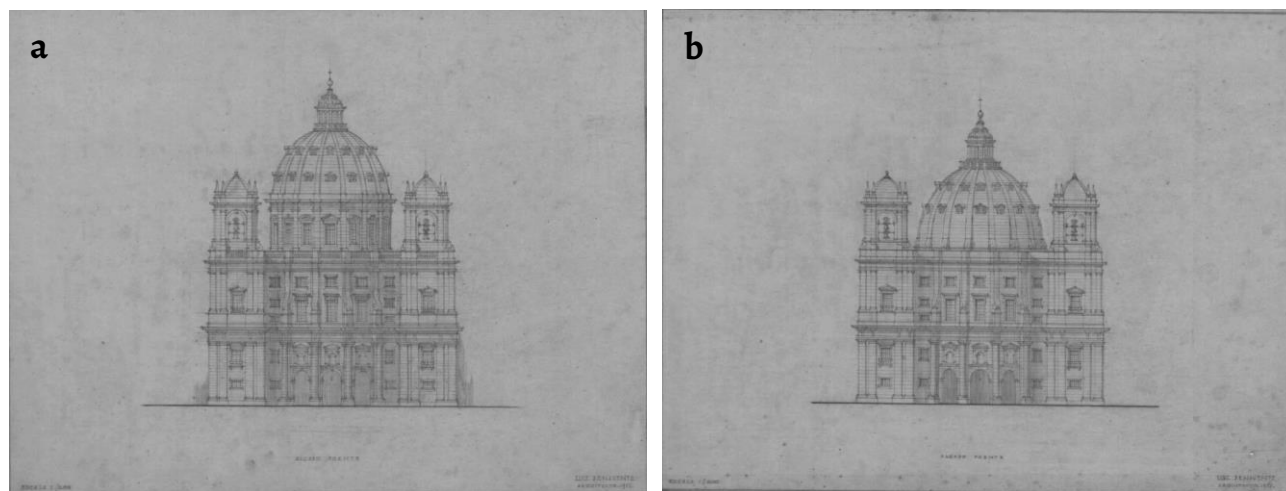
Propostas para conclusão da Igreja de Santa Engrácia, alçado principal, 1953: a) planta nº 4 e b) planta nº 5. ANTT, Espólio do Arquiteto Luís Benavente, Caixa 39, Pasta 268.
